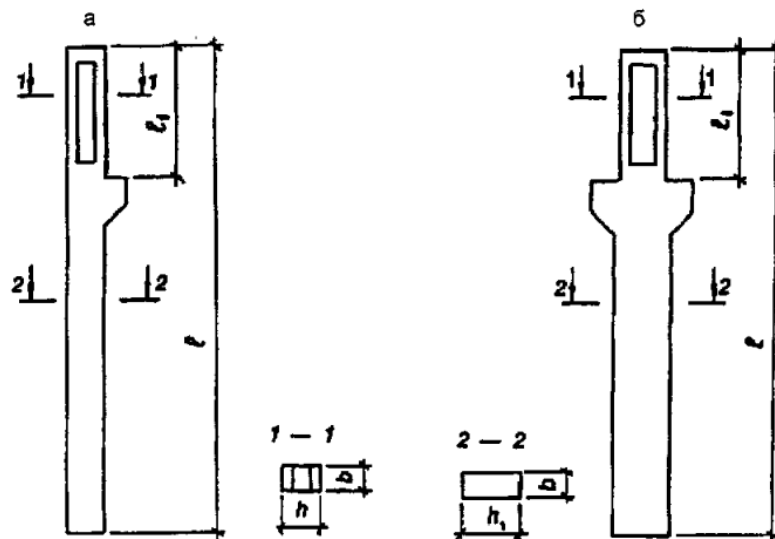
Залізобетонні колони ККС: а – колона для крайніх рядів; б – колона для середніх рядів.
